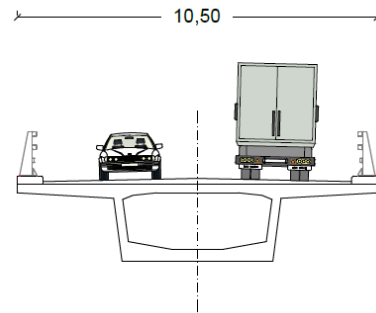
Sección del tablero del puente sobre el barranco del Convento
